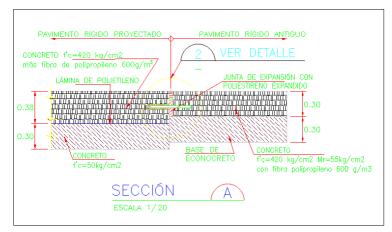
Vista de la distribución de la estructura de pavimento rígido.
